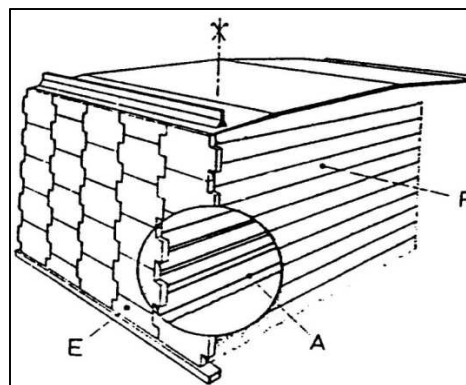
Mur enterre armée (A : armature, E : écaille, R : remblai)
